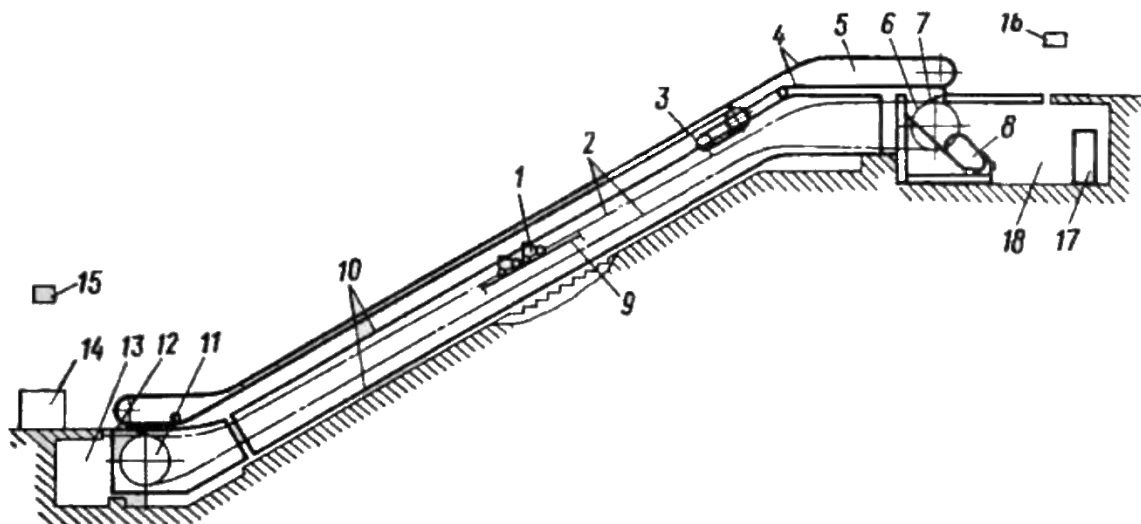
Общая схема тоннельного эскалатора: 1 – ступени; 2 – тяговые цепи; 3 – привод поручня; 4 – поручень; 5 – балюстрада; 6 – тяговая звездочка; 7 – верхняя площадка; 8 - передаточный механизм и механизм привода; 9 – направляющие; 10 – металлоконструкции; 11 - натяжная звездочка; 12 – нижняя площадка; 13 – натяжная камера; 14 – кабина оператора; 15, 16 – пульты управления; 17 – шкафы управления; 18 – машинное помещение
